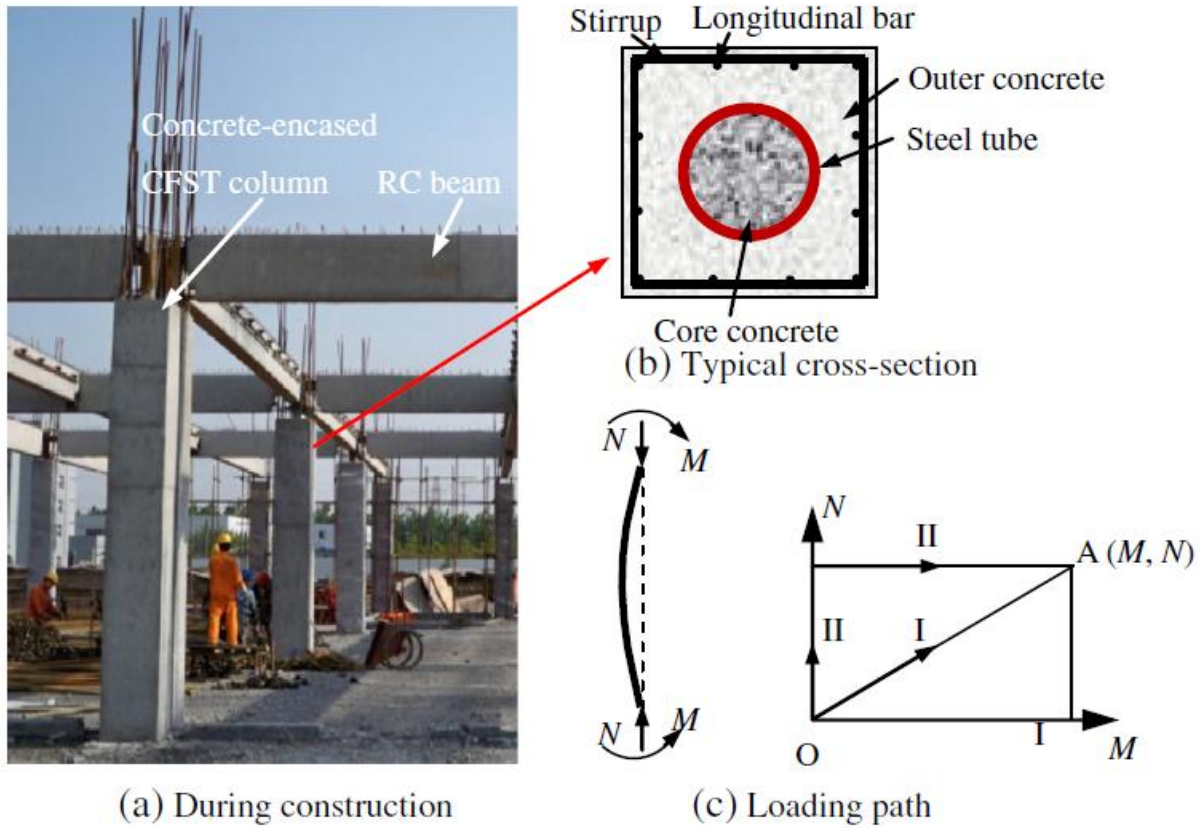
(a) Columna tipos CSFT durante la construcción, (b) Sección típica, (c) Ruta de carga. Fuente: Tomado de referencias (An & Han, 2014) , Pág. 316.
